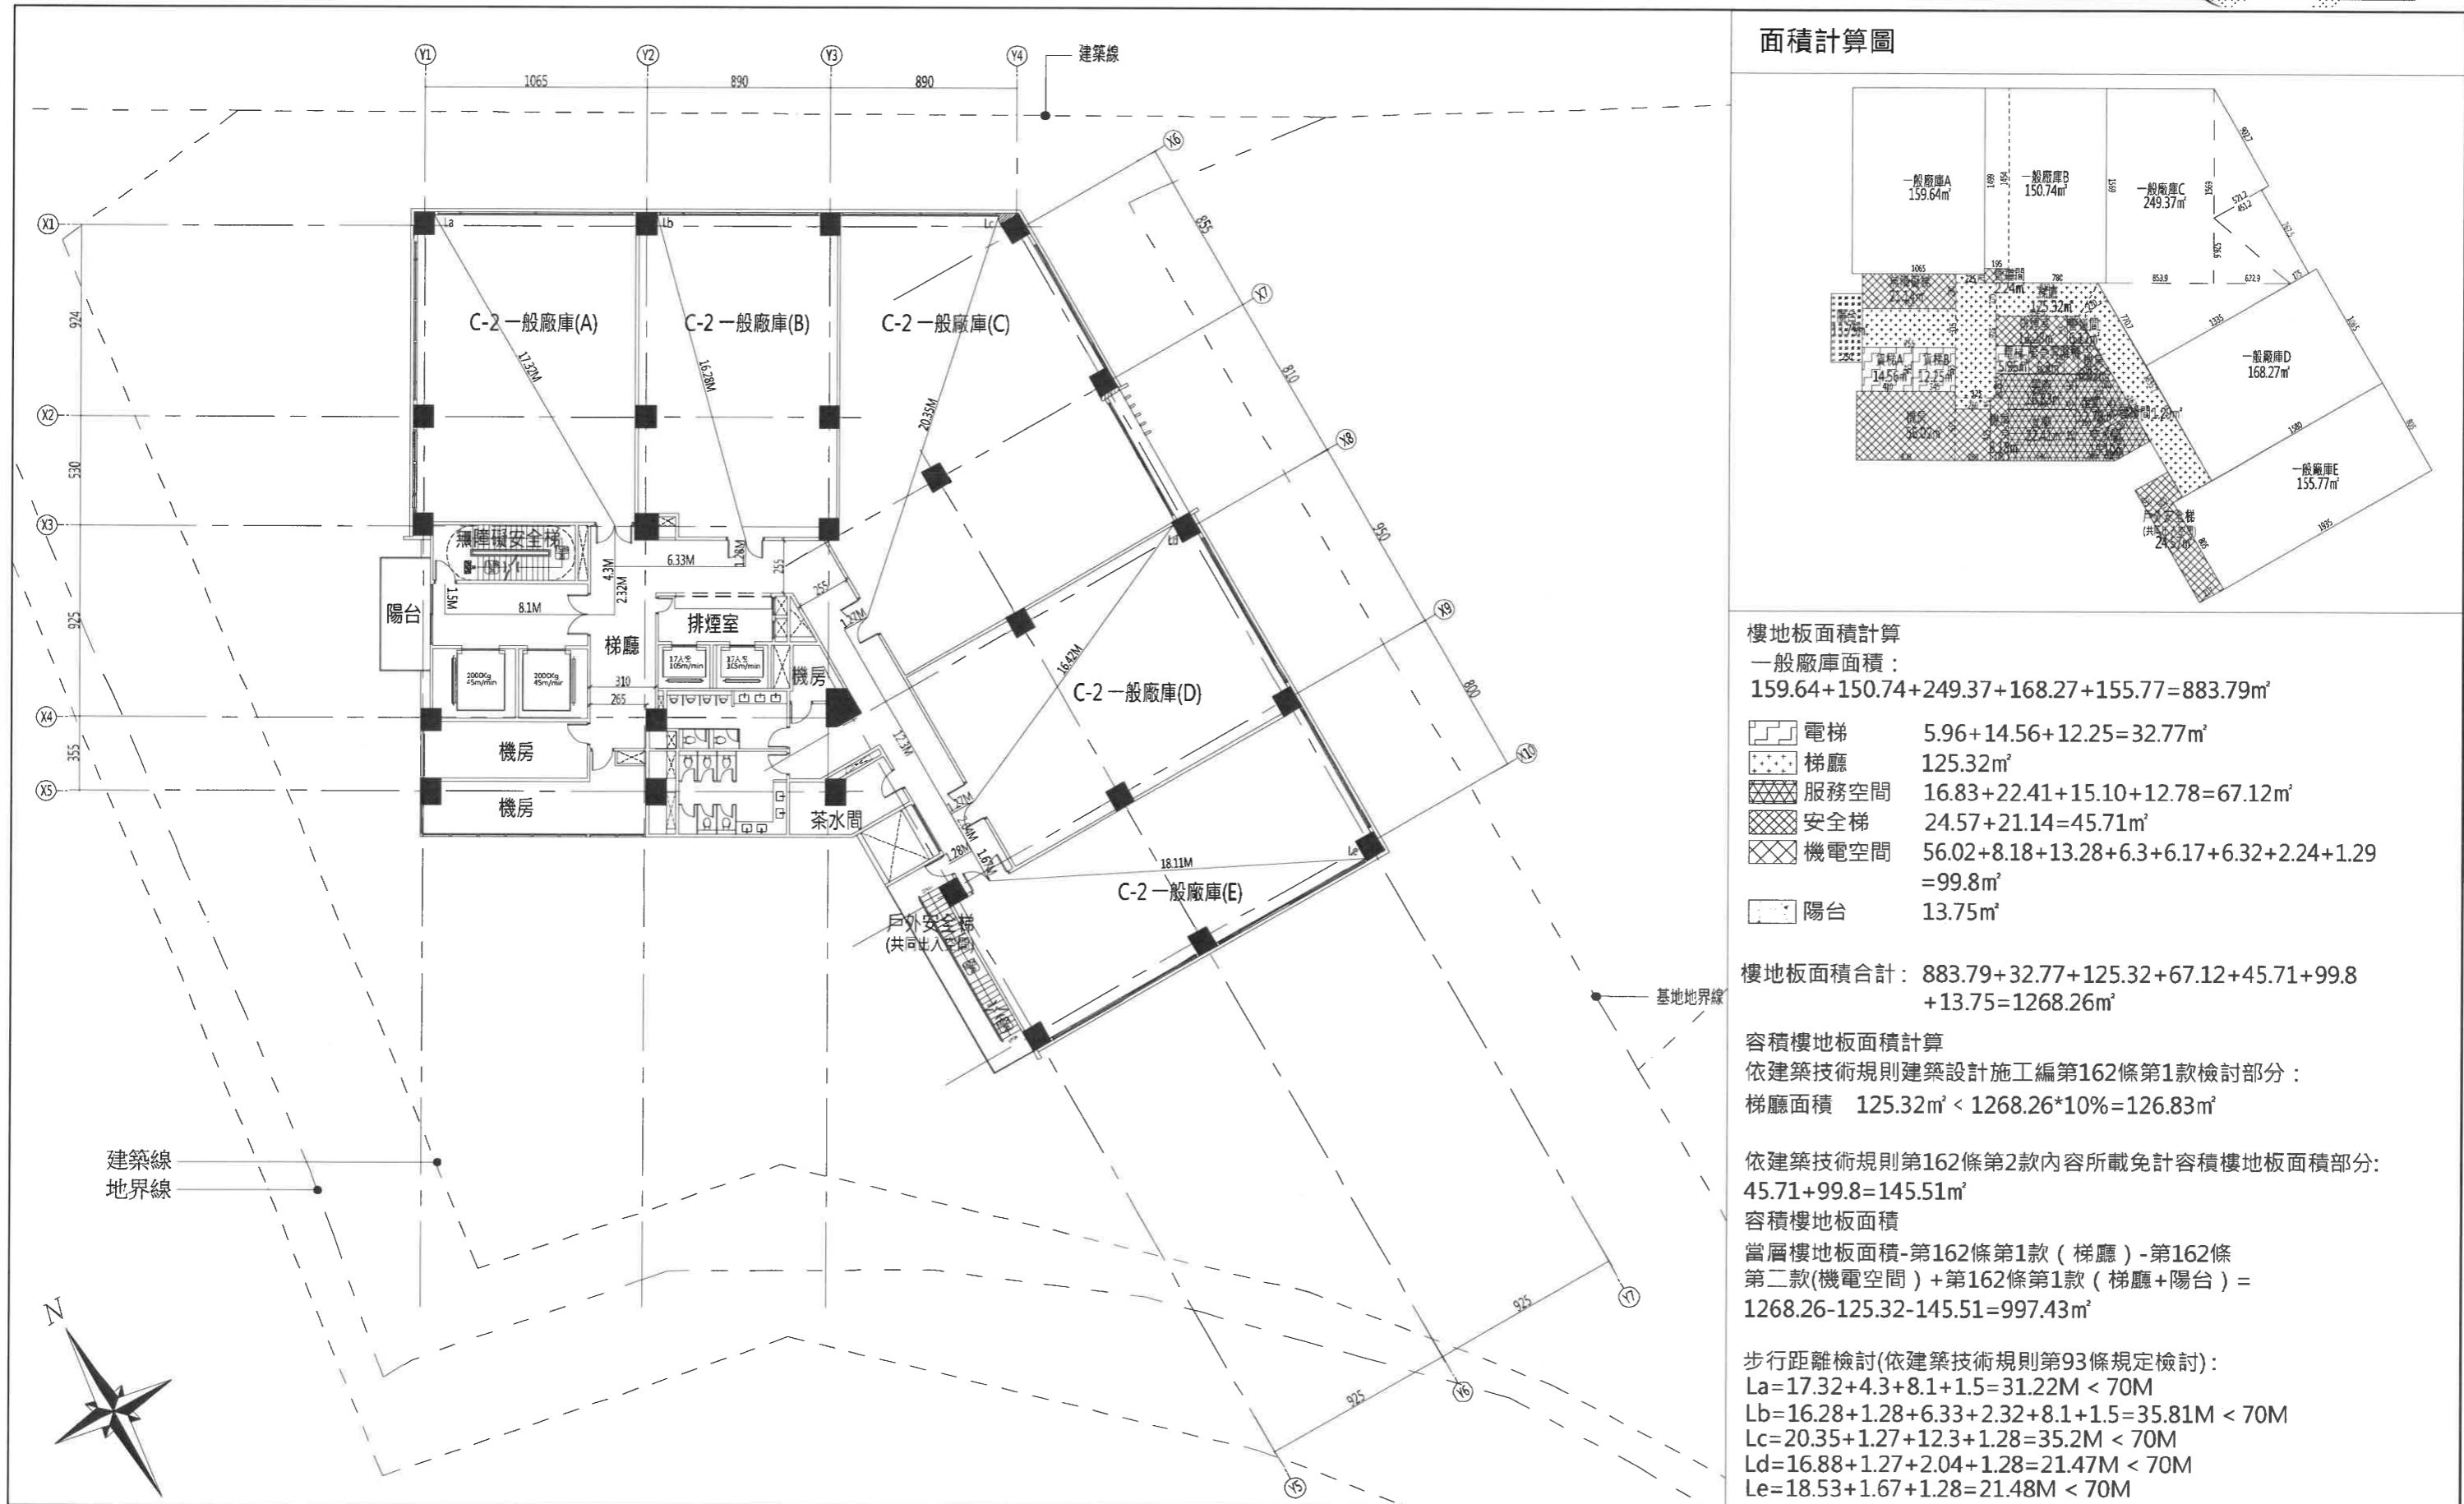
地上八層平面圖(原核定)(S : 1/300)
